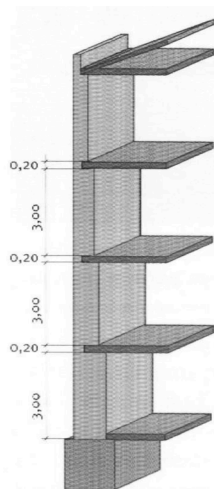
Espessuras da parede exterior (Appleton, 2003).
